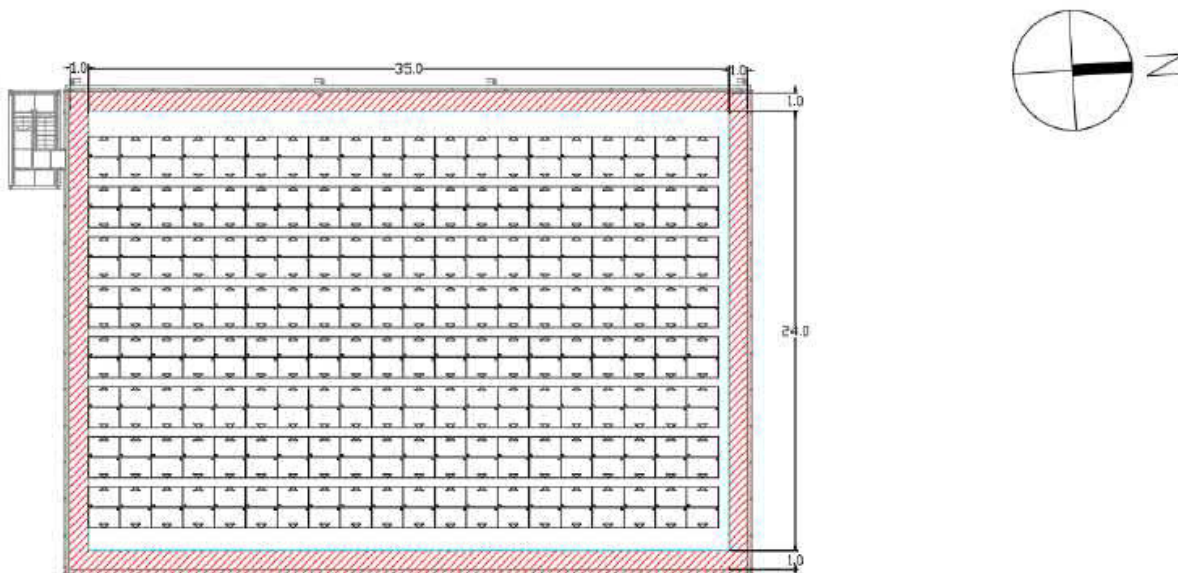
Dachfläche U-11/U-21; je Dachfläche ca. 320 Module, je Dachfläche ca. 128 kWp, Neigung 10°
